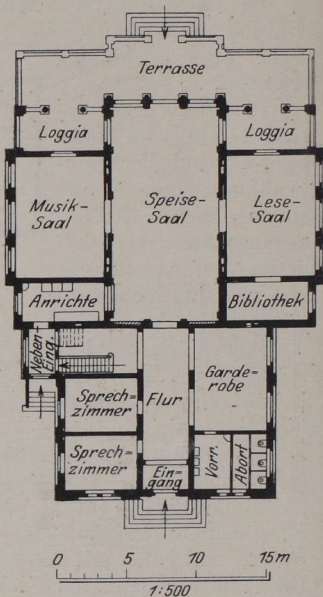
Hamburg-Barmbeck, städt. Krankenhaus. Schwesternhaus.
